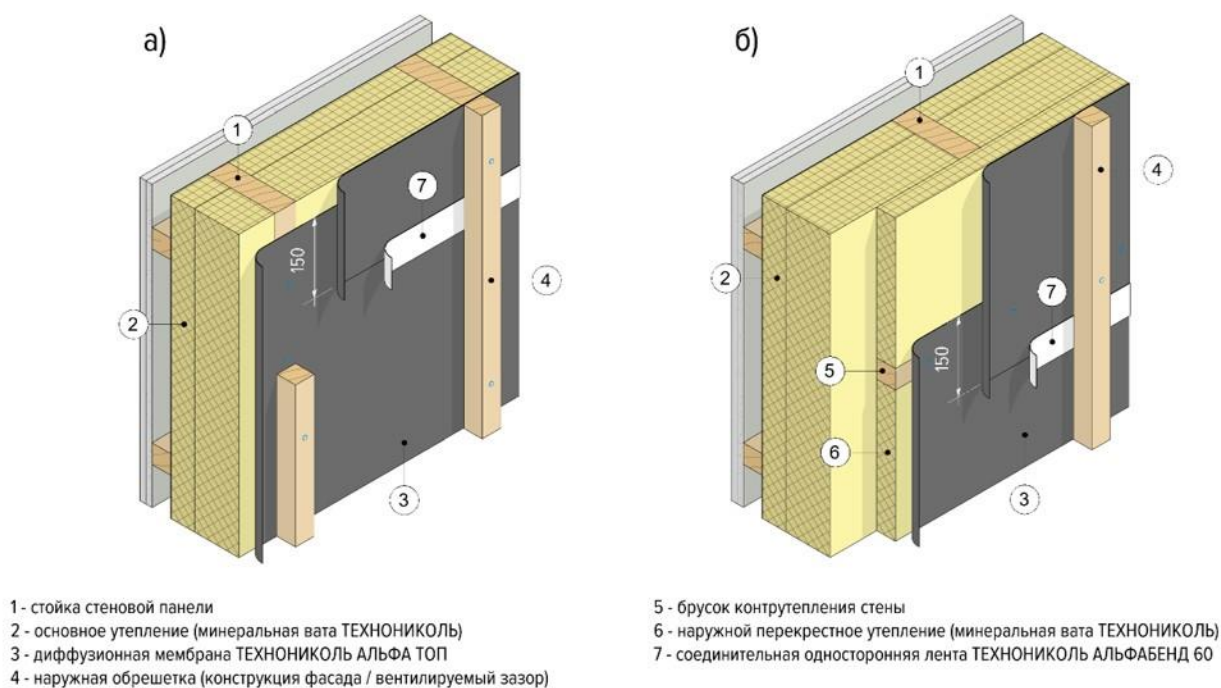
Монтаж гидро-ветрозащитной мембраны на наружные стены
